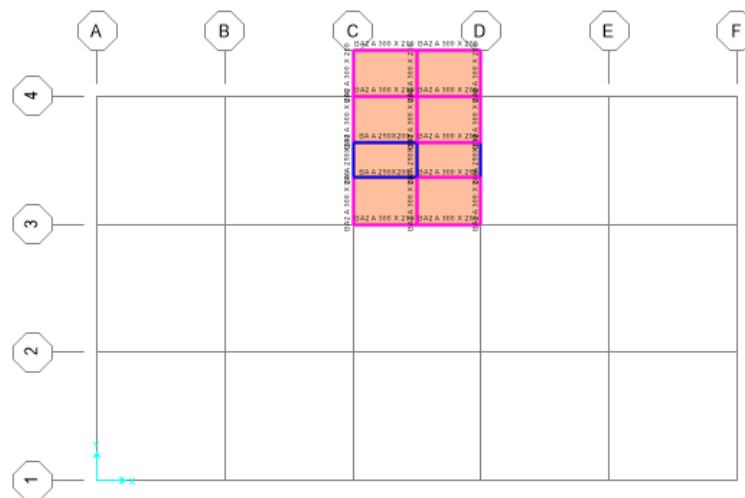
21 Permodelan Balok dan Pelat Lantai 6
